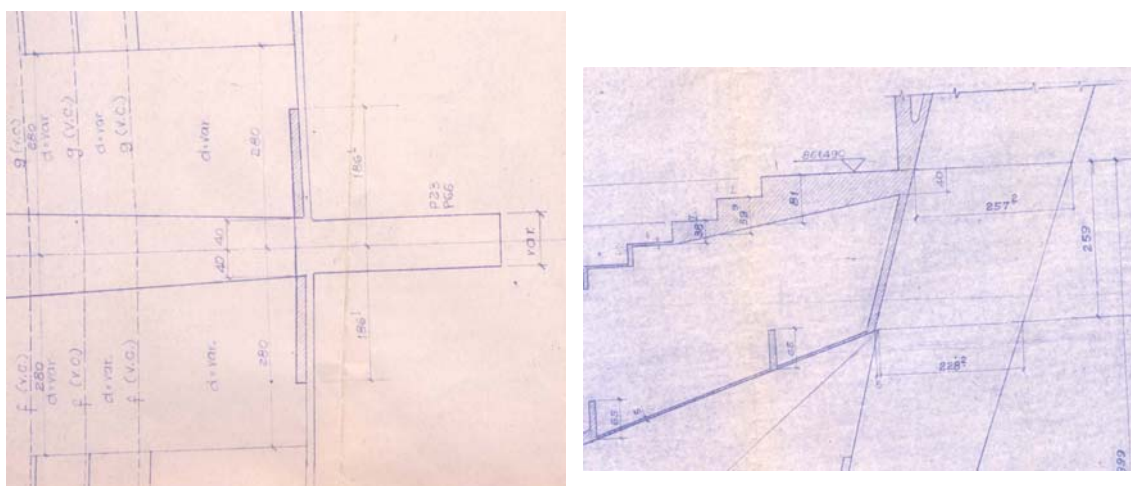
Fac-símile do projeto estrutural (planta e corte) da região de ligação da vigaparede, pilar externo, viga e laje da arquibancada
